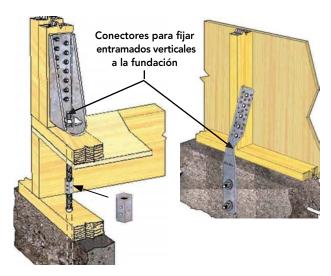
Alternativas de conectores metálicos para fijar elementos verticales como tabiques o pie derecho.
